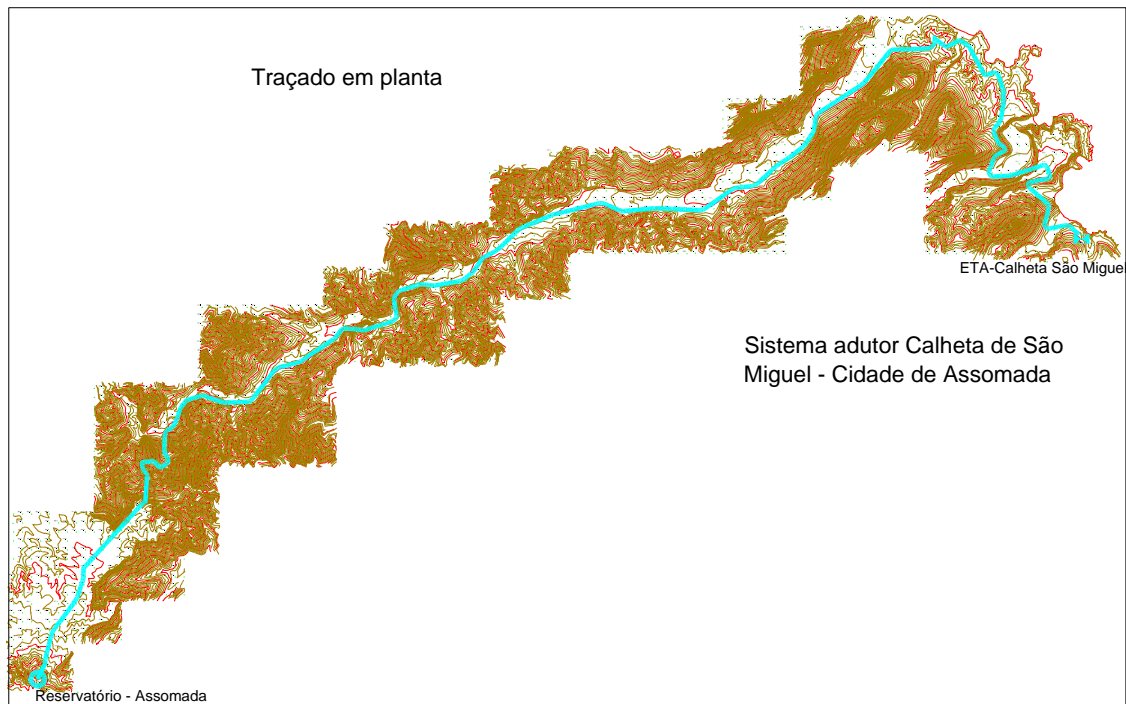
6 – Traçado em planta do Sistema adutor Calheta de São Miguel – Cidade de Assomada.
